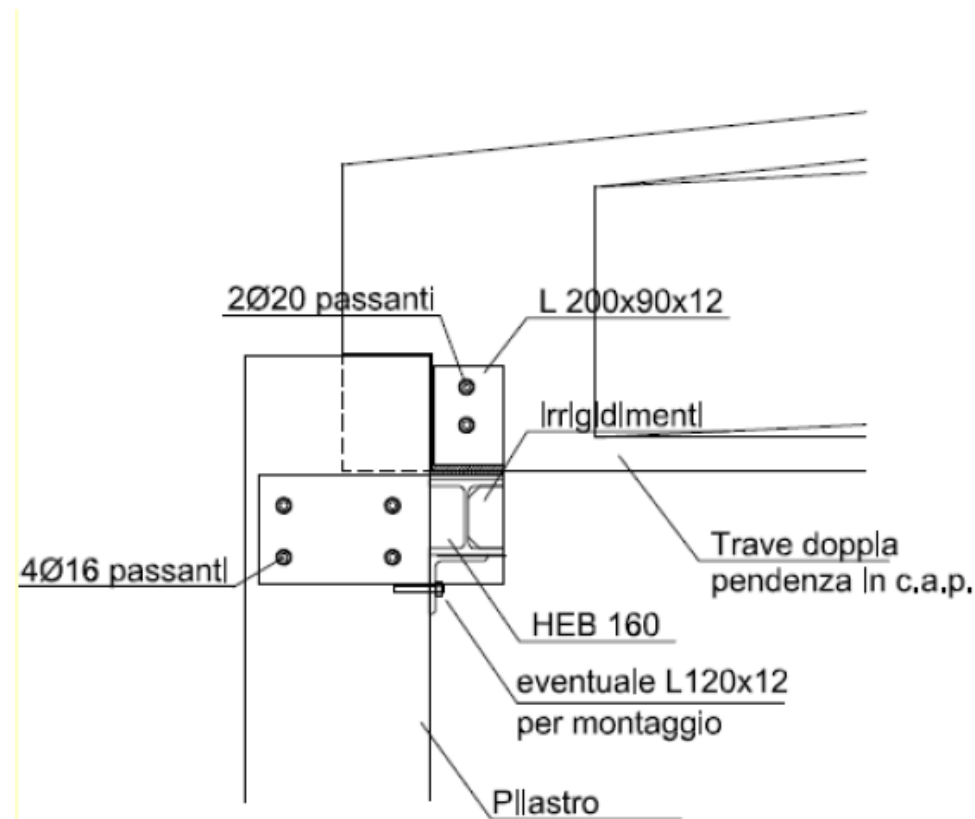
dispositivo di collegamento della trave L di bordo al pilastro (sulla mensola)
